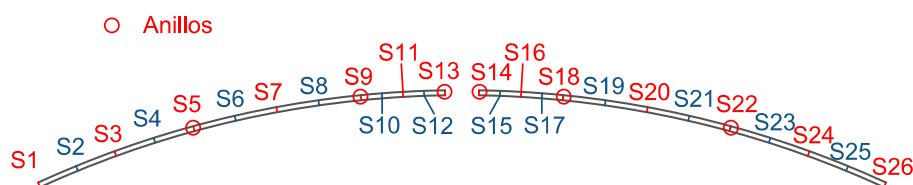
Secciones en las vigas meridianas para las verificaciones estructurales
